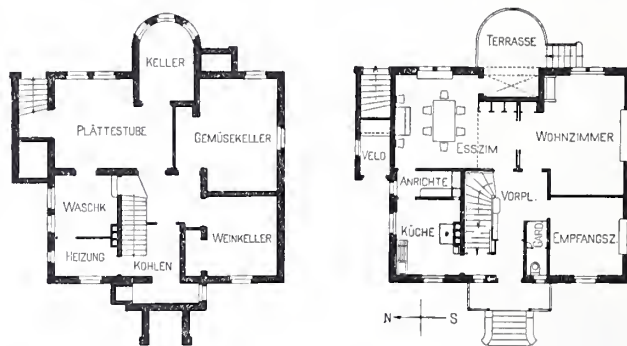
und 4. Grundrisse vom Kellergeschoss und Erdgeschoss. Masstab 1:400.
